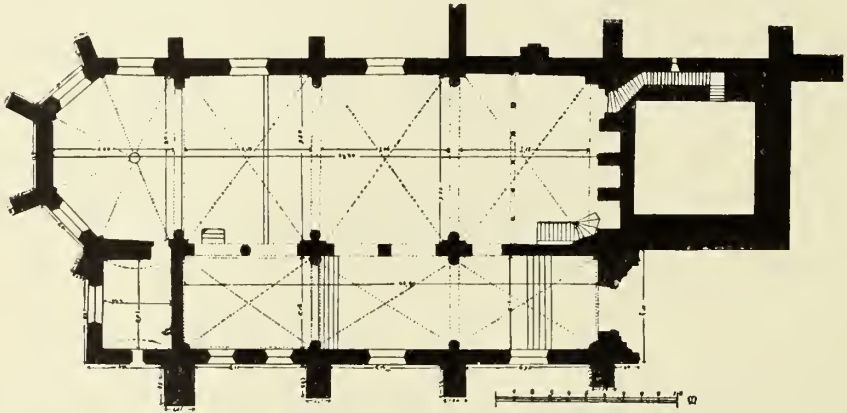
Hochelten. Grundriss der Stiftskirche
